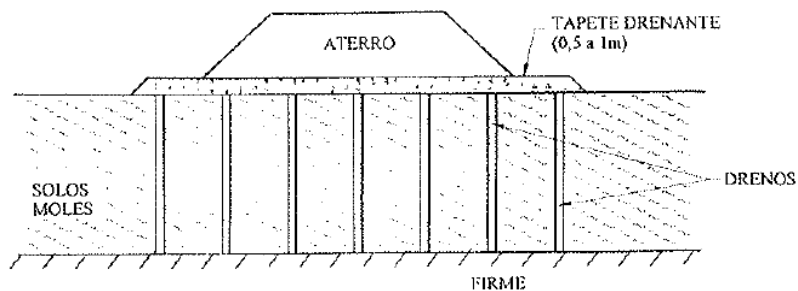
Esquema de aplicação de drenos verticais (Borges, 1997).
